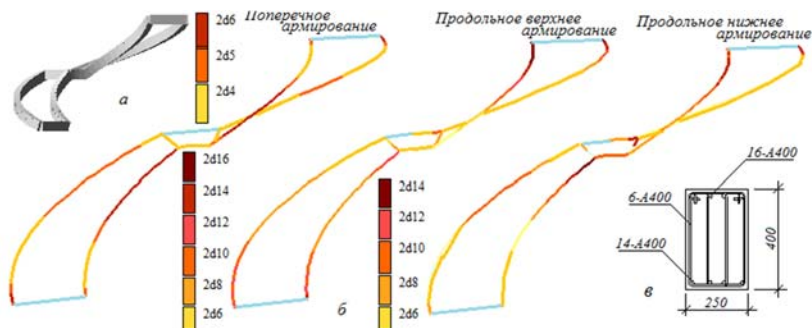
Армирование несущих стержней-брусьев криволинейной лестницы: а – расчетная схема, б – графическое представление подбора арматуры, в – армирование в поперечном сечении продольного бруса
